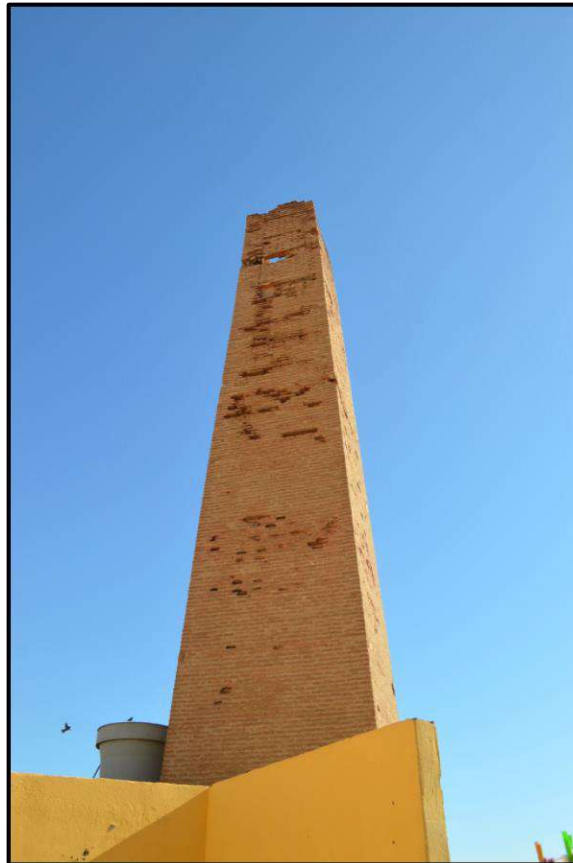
Base de la chimenea de la Fundación Santo Tomás, ubicada en el patio de una vivienda. Autoría propia.
